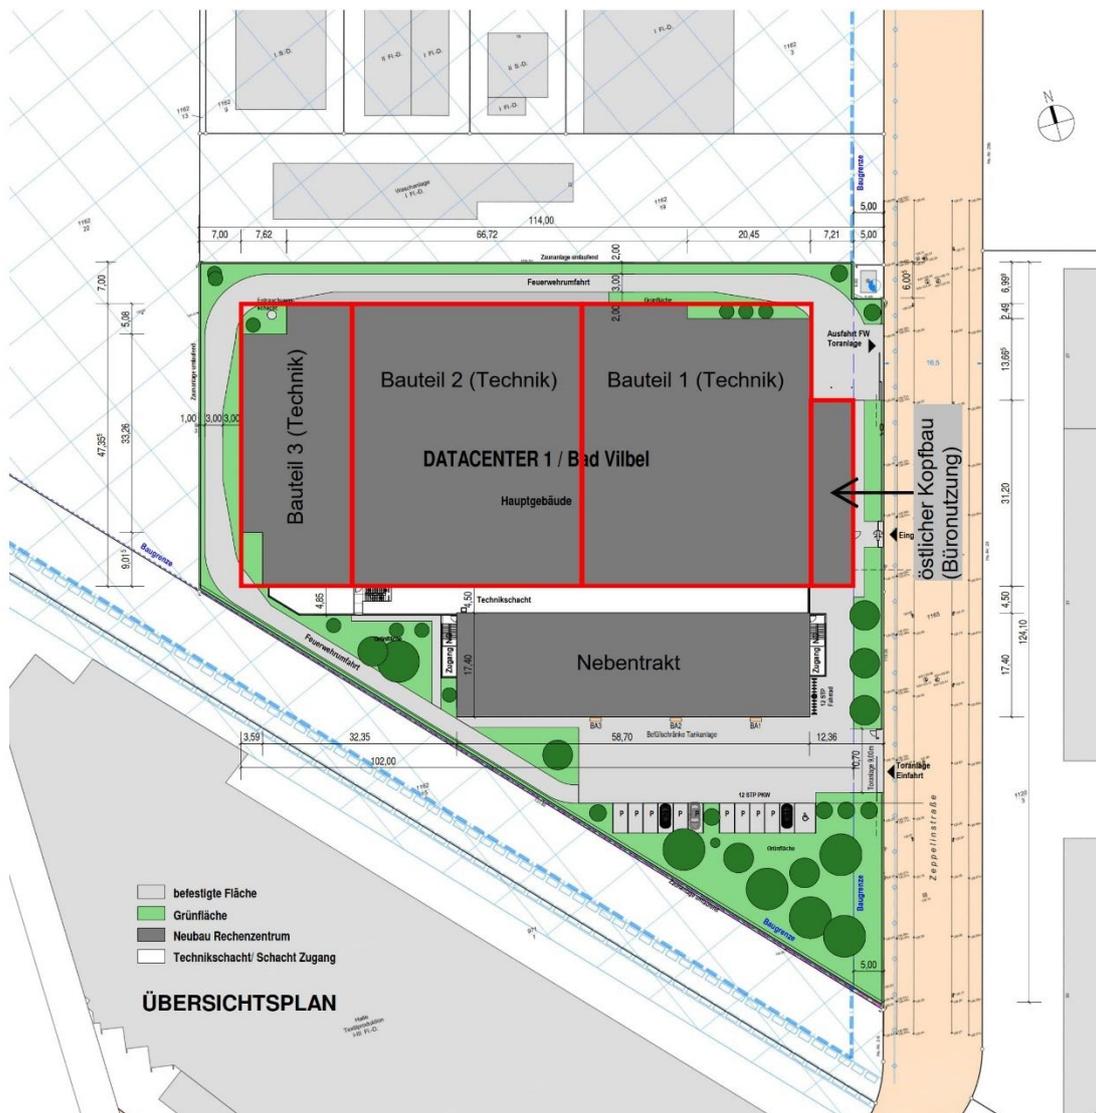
Plan der Rechenzentrumsgebäude [4]
